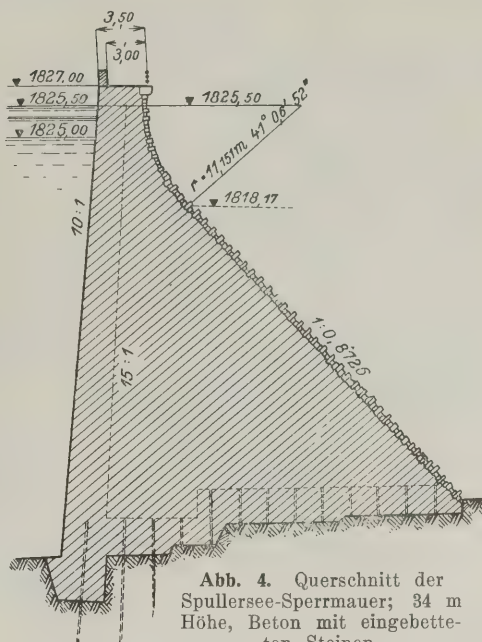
Querschnitt der Spullersee-Sperrmauer; 34 m Höhe, Beton mit eingebetteten Steinen.
